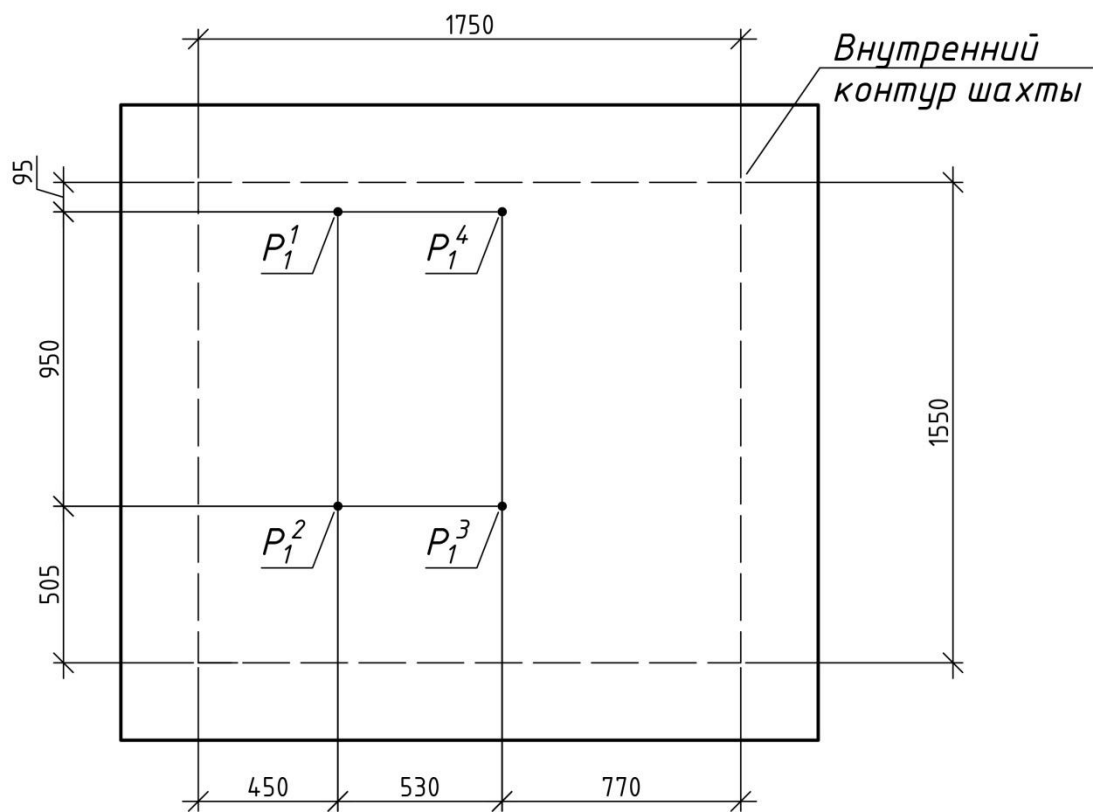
Нагрузки на плиту перекрытия шахты от лифтового оборудования.
